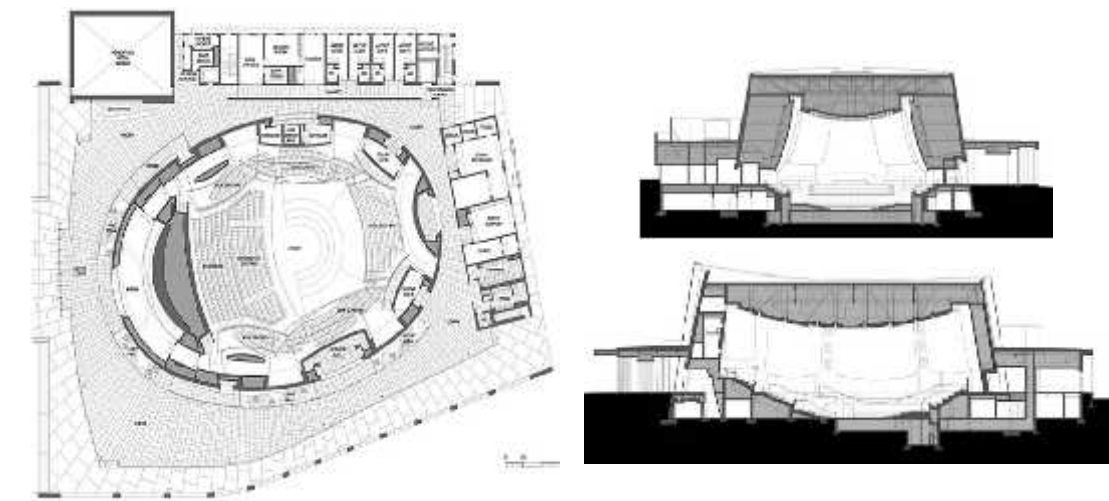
Planos del Bing Concert Hall Fuente: Rinaldi (2016)
